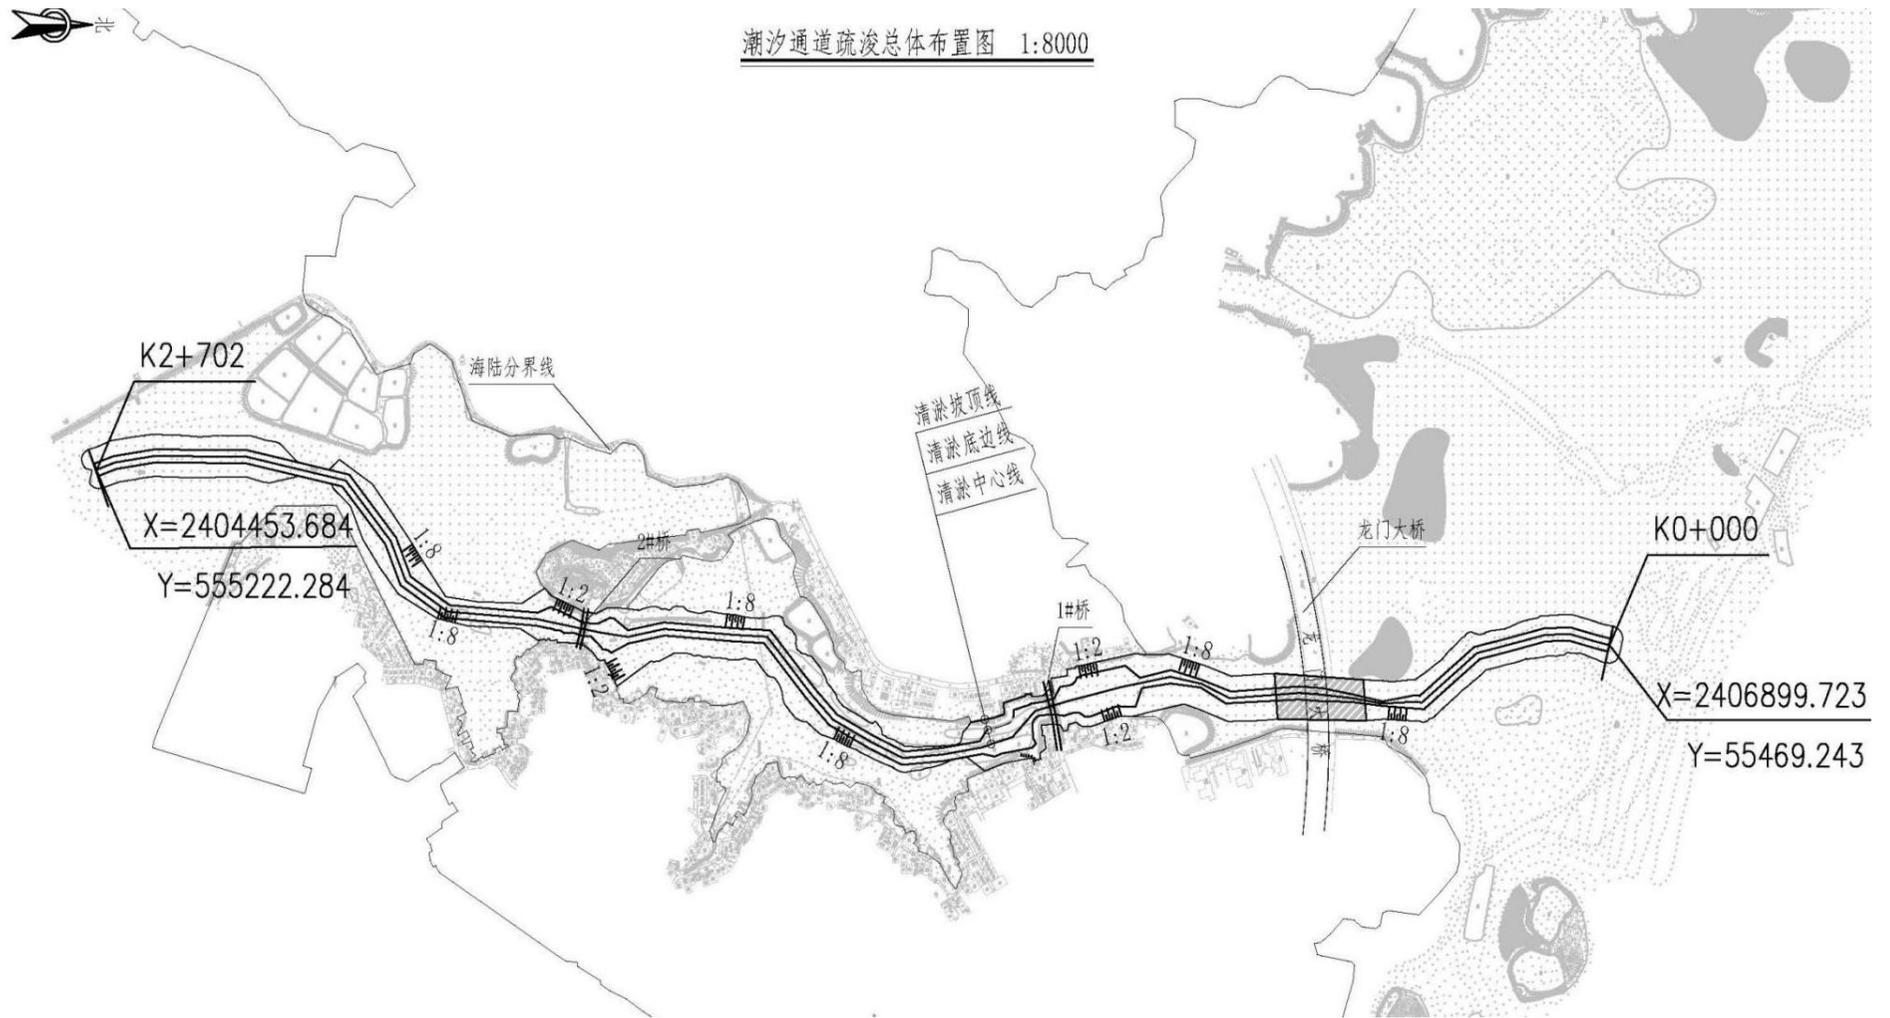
b 潮汐通道疏浚总平面布置图 2
